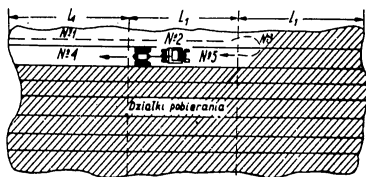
Wpływ wstępnego przygotowania gruntów na zasadnicze współczynniki poboru:
